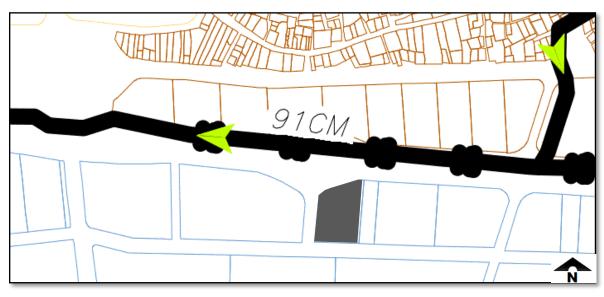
Infraestructura Drenaje Pluvial. En el croquis se muestran un extracto de las líneas de drenaje pluvial que pasan por el sitio de trabajo.
